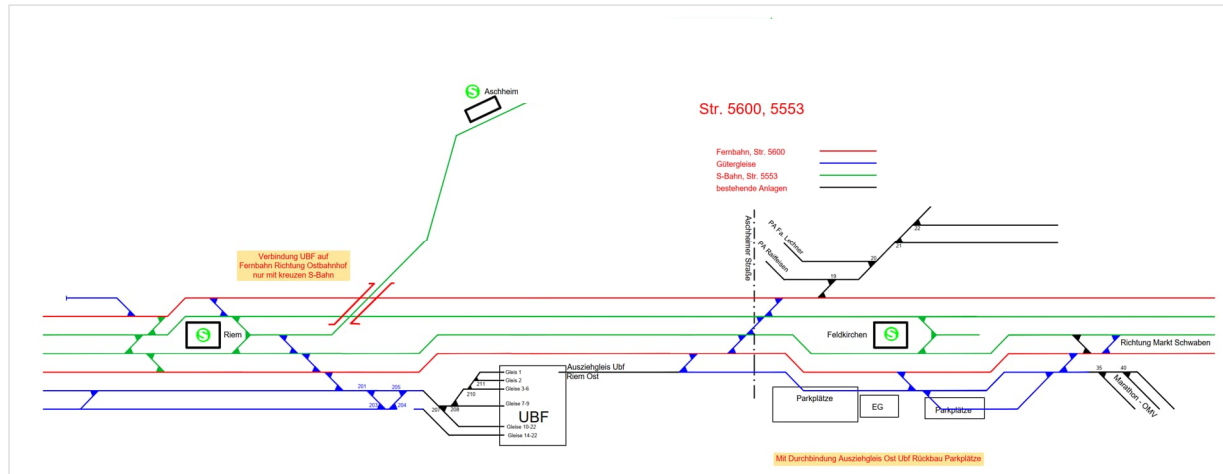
Vorzugsvariante mit Vollausbau U02
